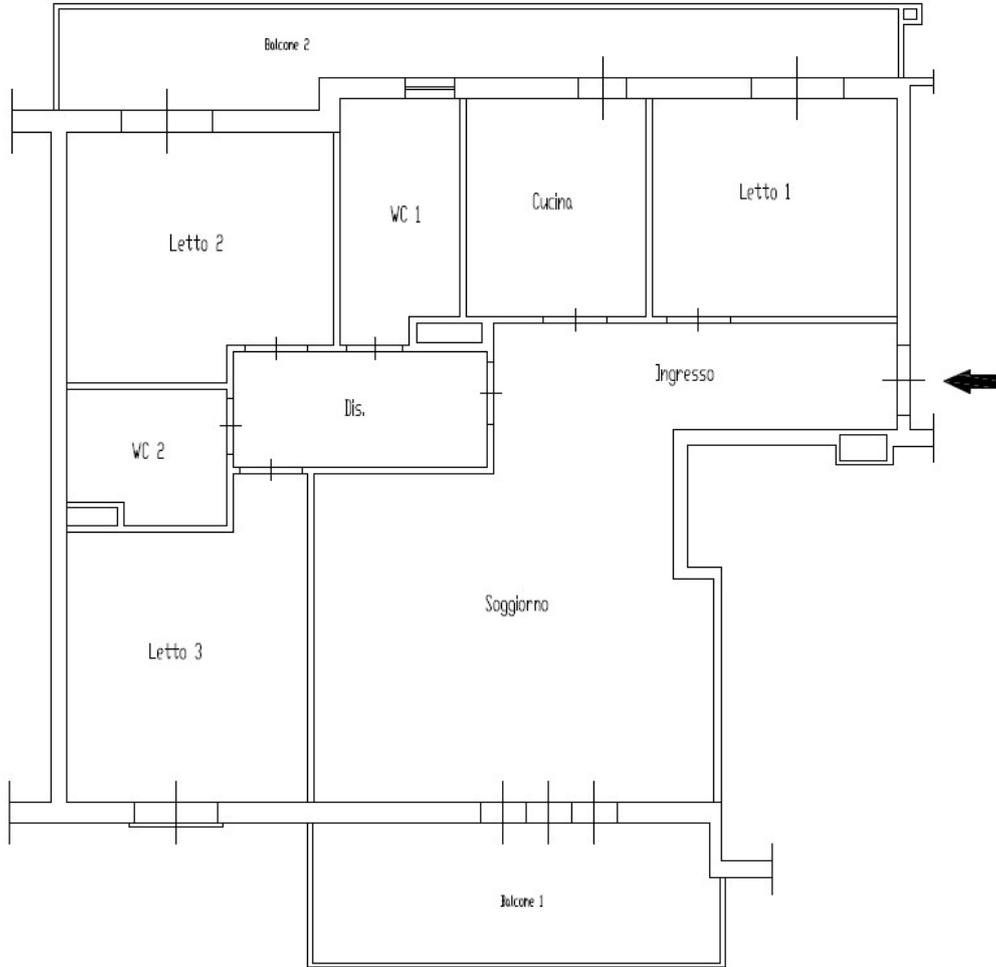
Planimetria dell'appartamento oggetto di pignoramento- interno 7
